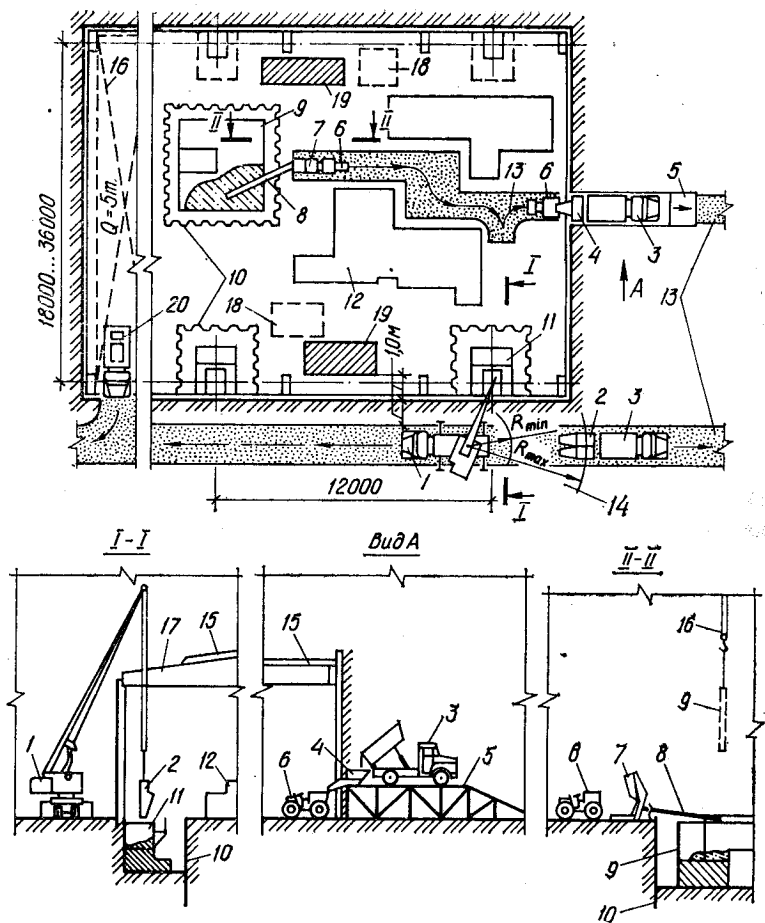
Схема устройства фундаментов под колонны стреловым краном через проем в покрытии и фундаментов под оборудование вибротранспортом:
